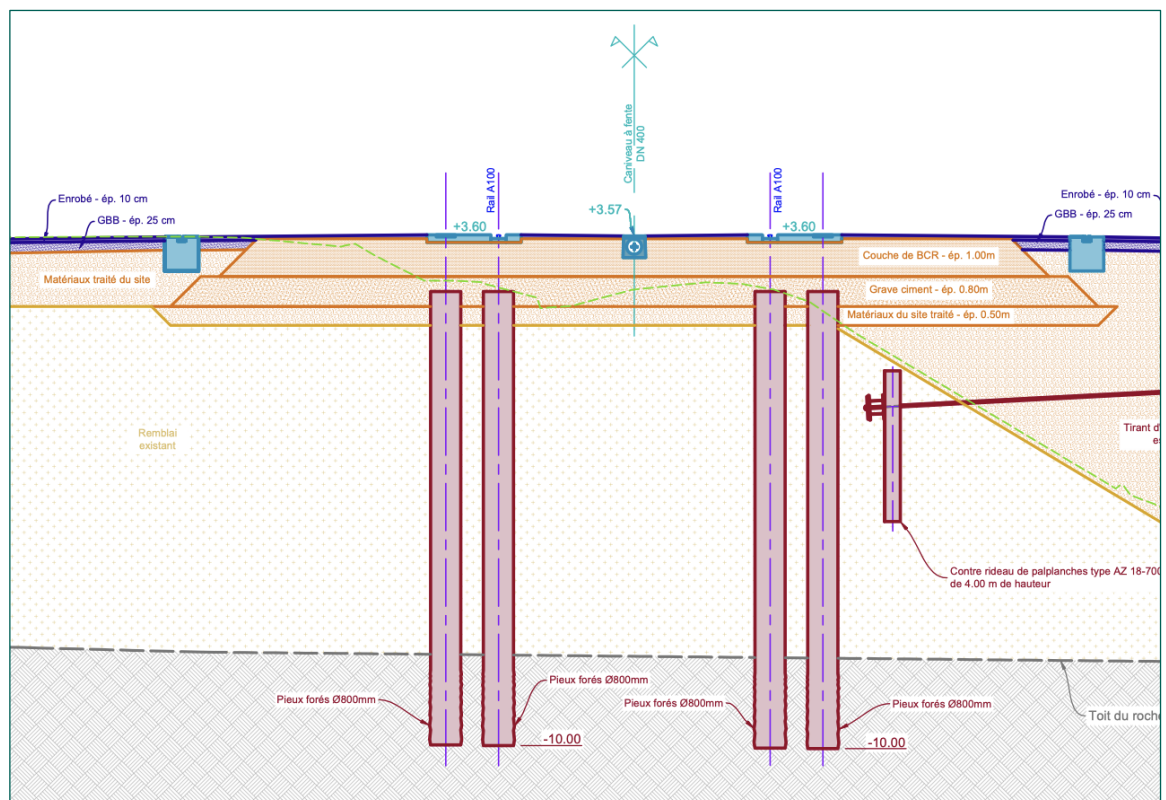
Plan de principe du renforcement par fondation profonde (micro pieux) de la plateforme
